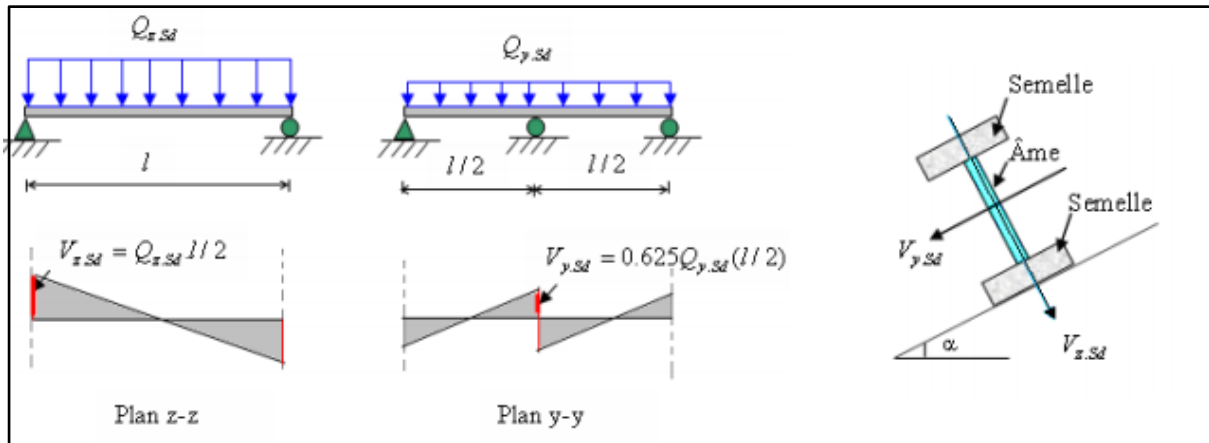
Panne de toiture en cisaillement sous différents plans de chargement.
